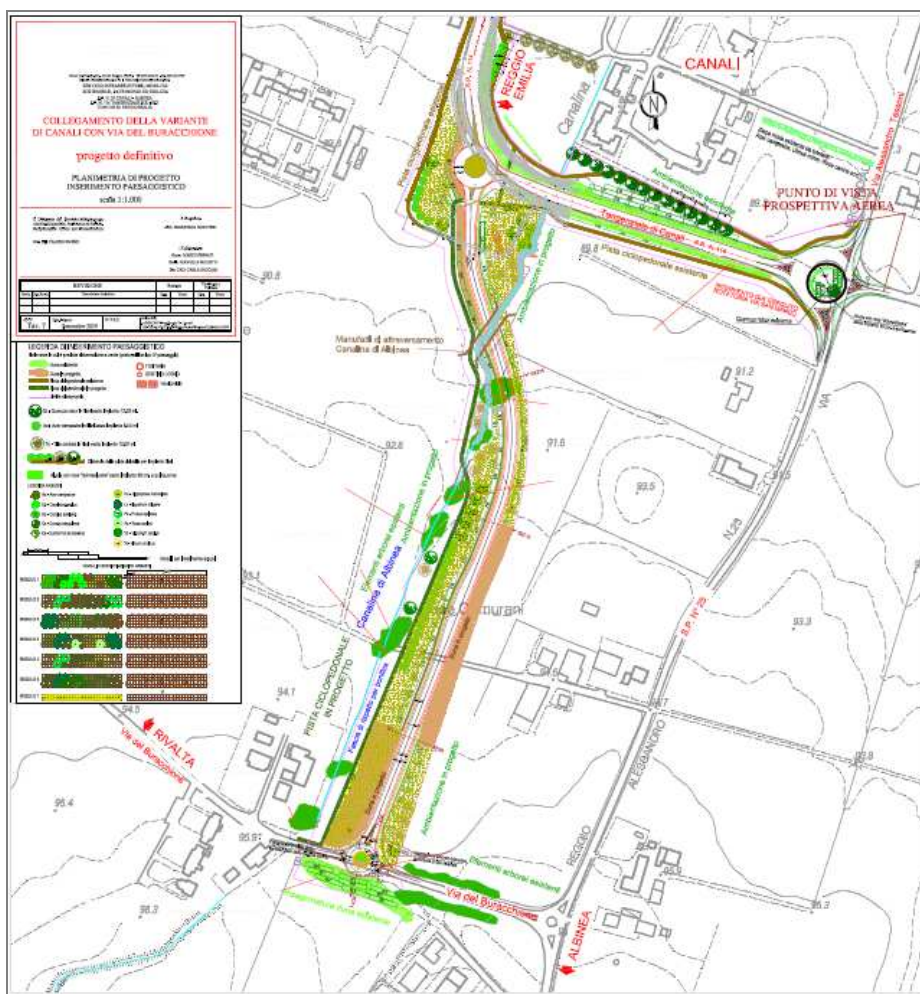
Planimetria di Progetto – Inserimento paesaggistico
